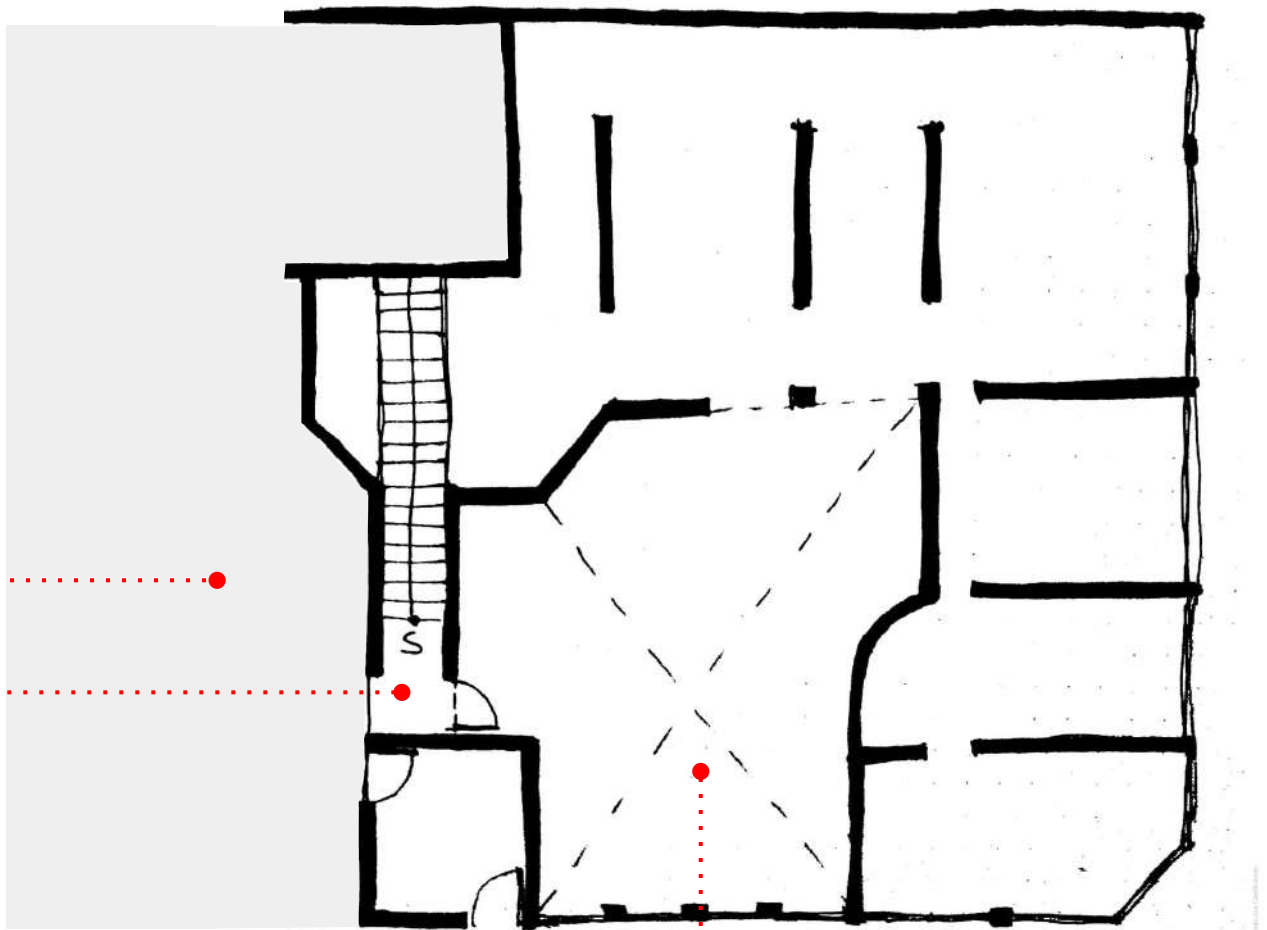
Circulación vertical conectando con Planta Alta.
